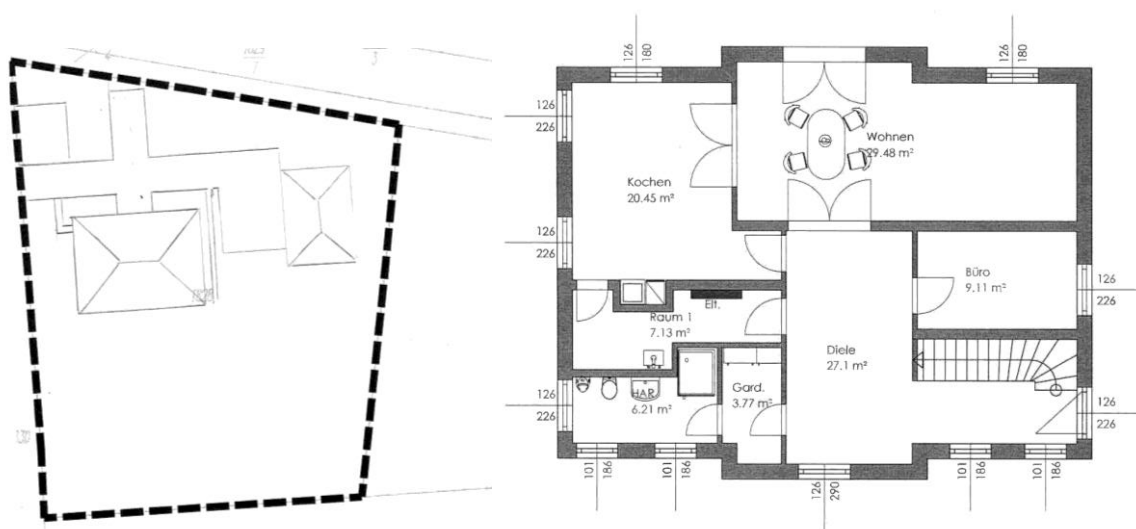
, 2: Skizze geplante bauliche Nutzung, Planung Grundriss EG
